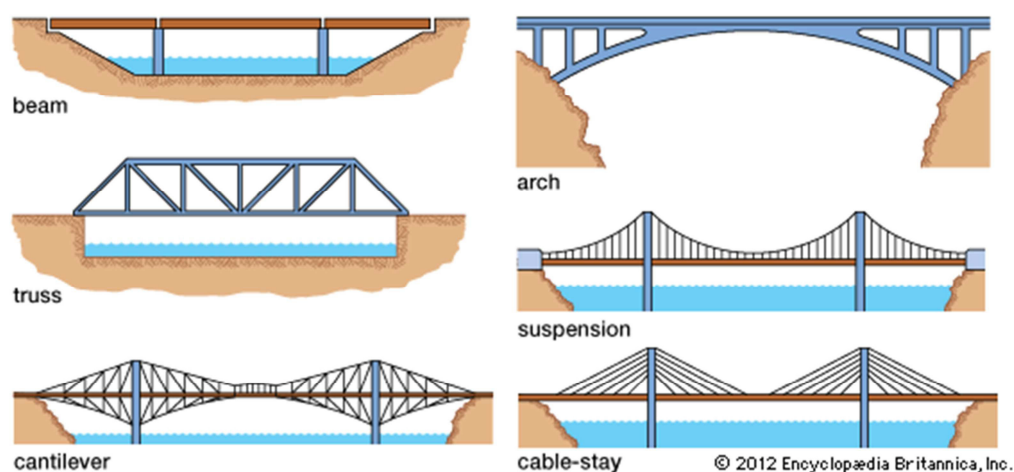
Tipos de puente de acuerdo a la forma estructural
